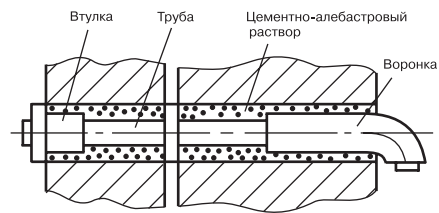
Конструкция для прохода стены при вводе в дом
